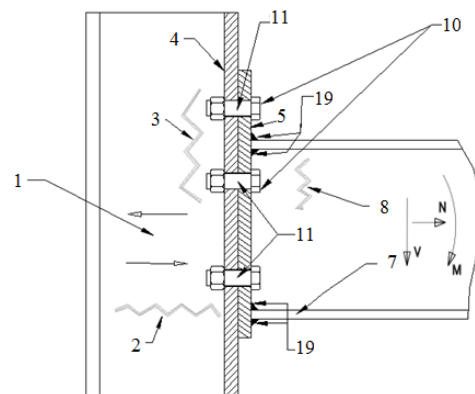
Componentes de uma ligação viga-pilar com placa de topo.
